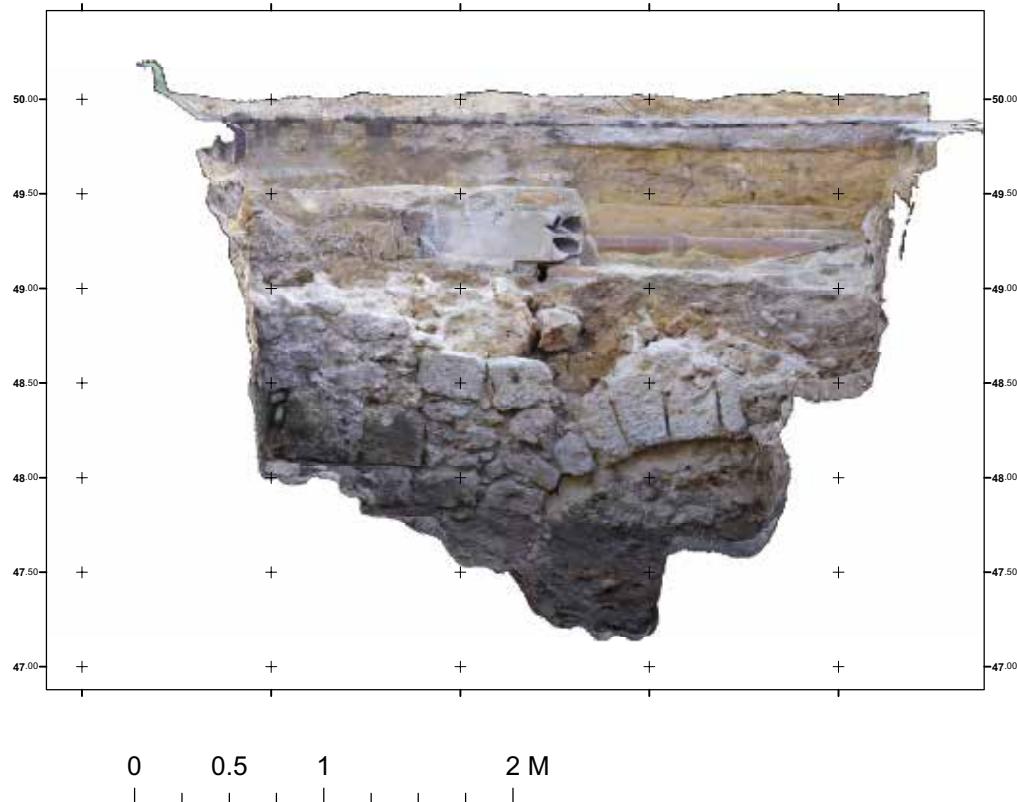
Photographie redressée du parement de l'ancien pont d'Arpajon (Sondage 20). © R. Touquet, Inrap.
